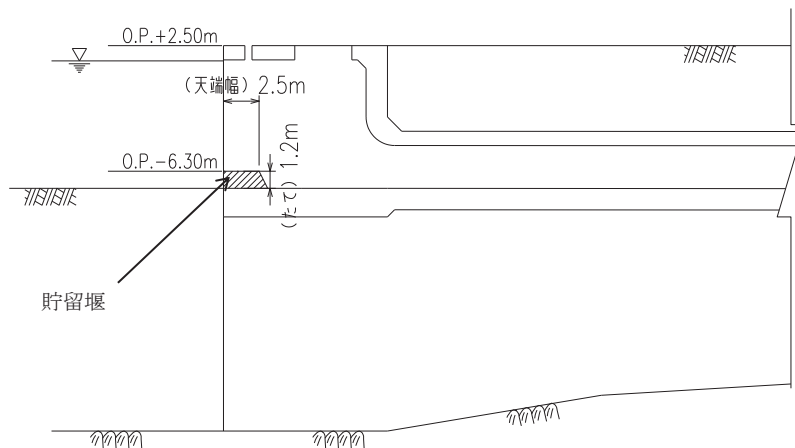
貯留堰（取水口）縦断面図（B-B）
